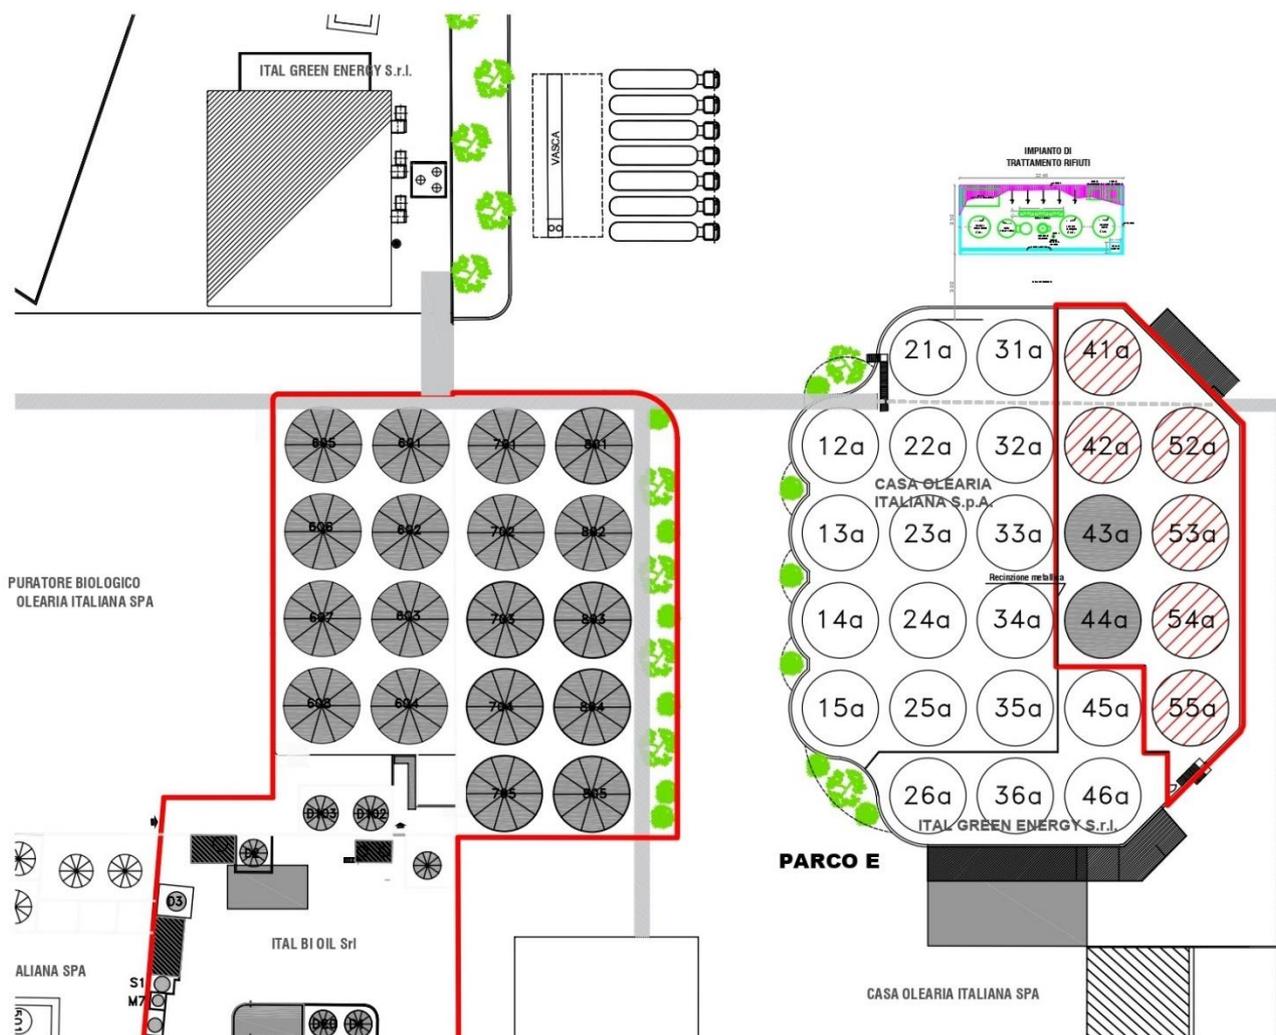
localizzazione dell'impianto di trattamento rifiuti
